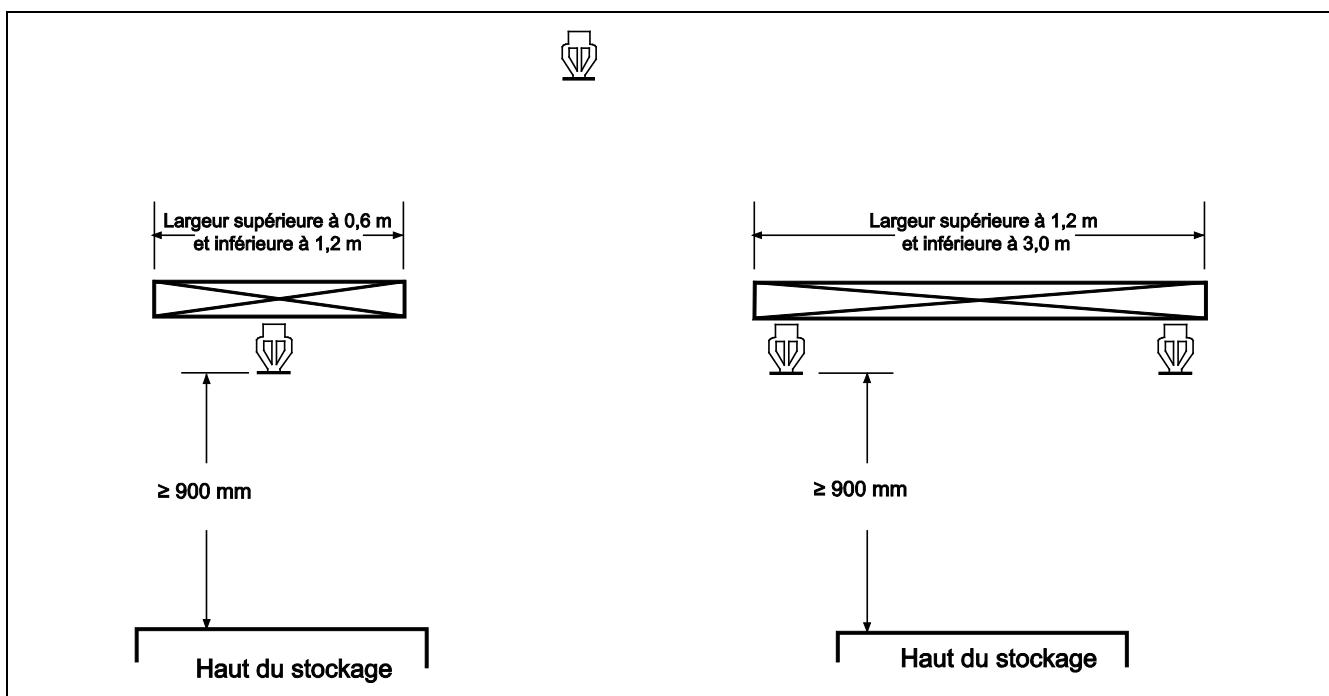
Sprinkleurs supplémentaires installés sous des obstructions pleines, plates ou continues d'une largeur comprise entre 0,6 m et 3,0 m.
